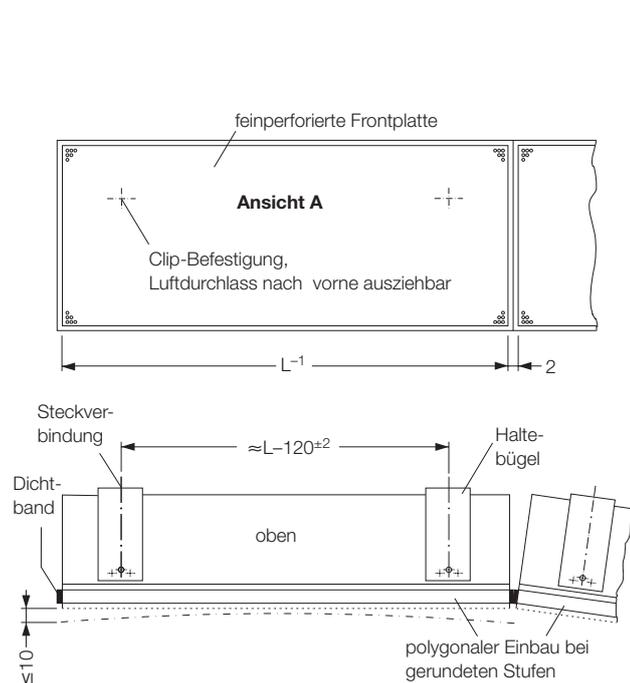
Ausführung ohne Blendrahmen für Befestigung mit Haltebügel
